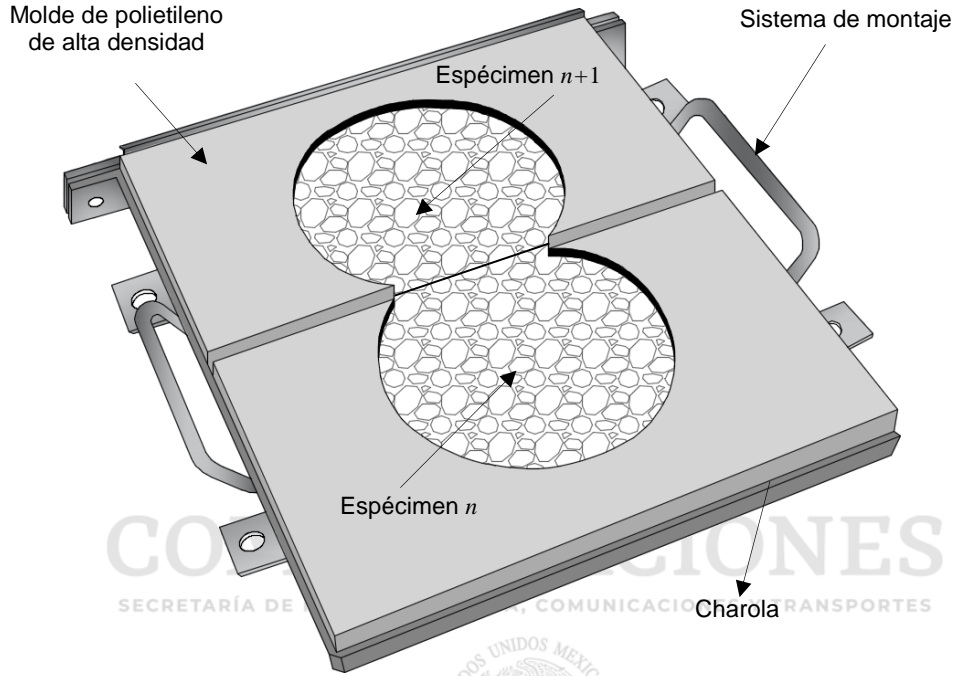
Sistema de montaje con molde para espécimen cilíndrico de 150 mm de diámetro
